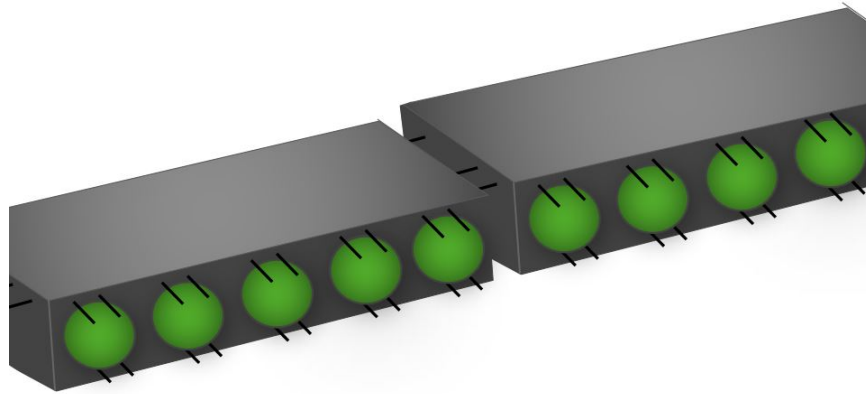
Lajes pré-moldadas com vazios (fonte: Autor)
